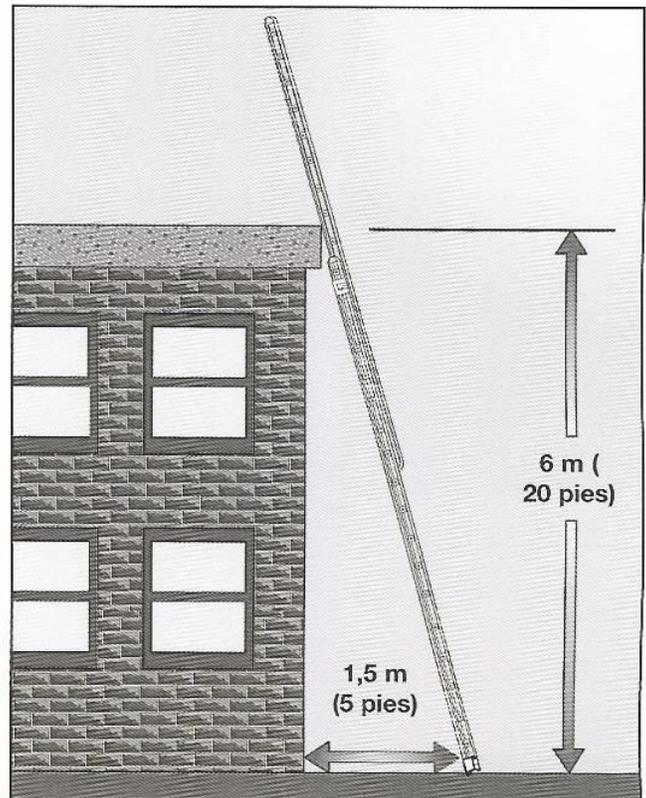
Una escala que se levanta 6 m (20 pies) debe tener la base a 1,5 m (5 pies) del edificio.
